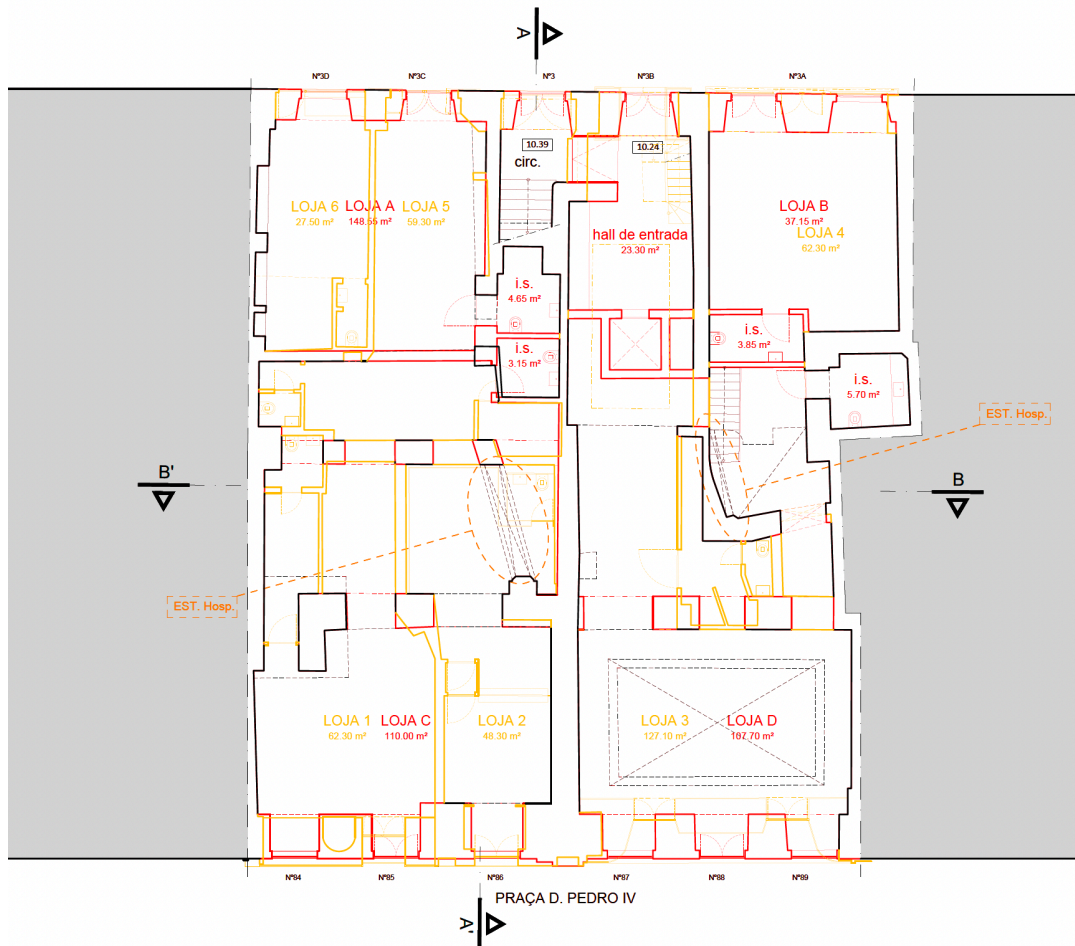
Planta do piso térreo, mostrando as alterações propostas para reorganização das lojas.
